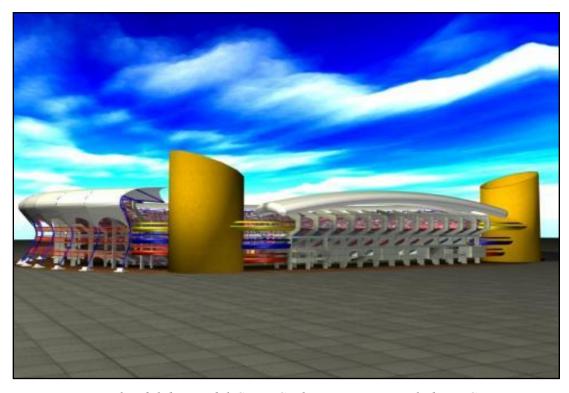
D del diseño del C.T.E Cachamay. Fuente: Bladimir Cova
